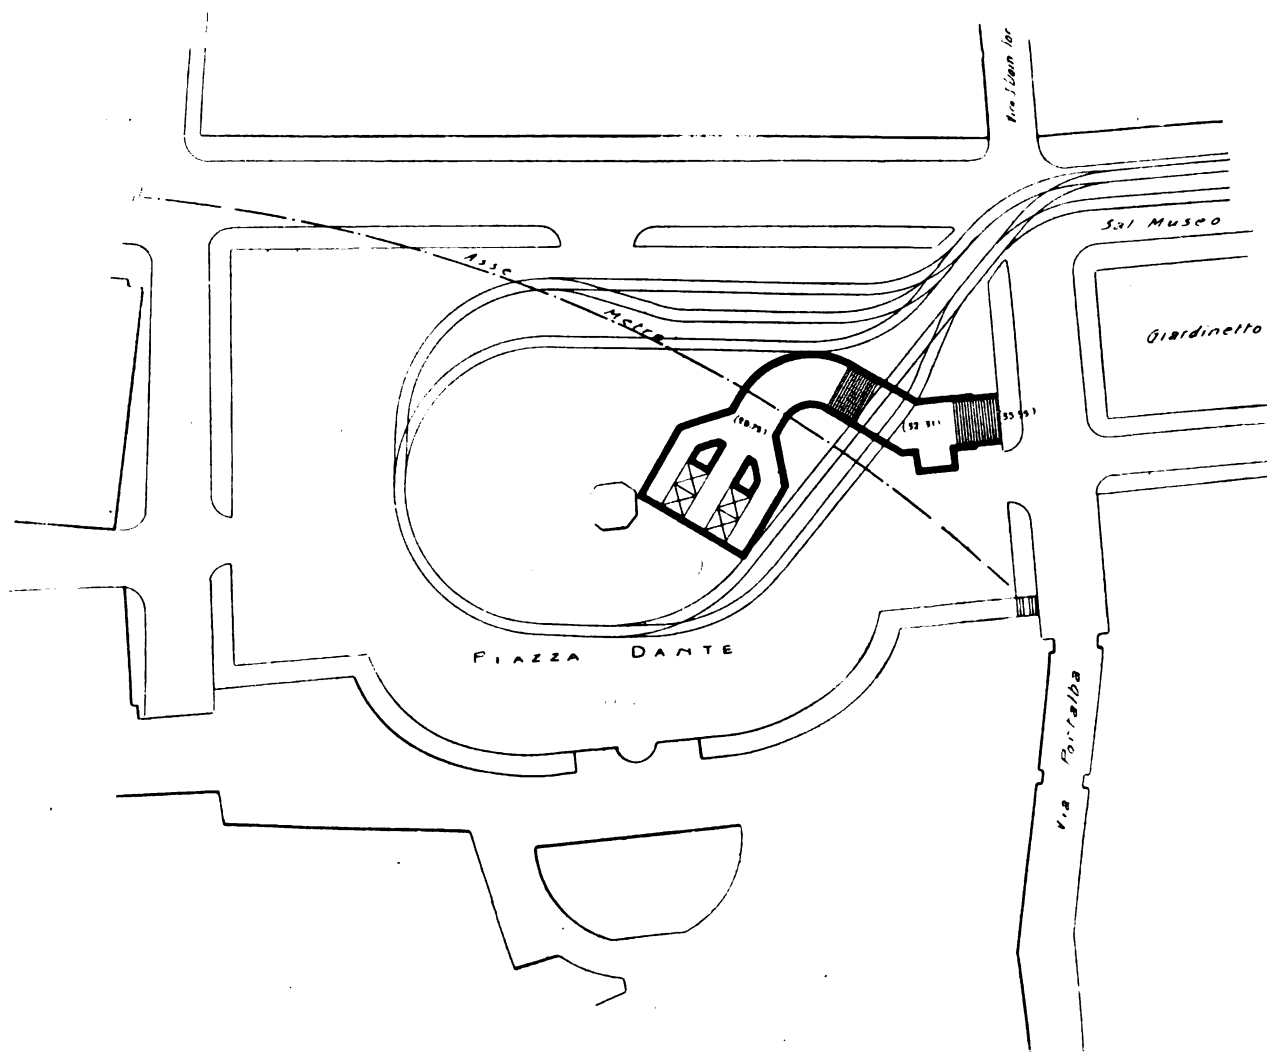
Stazione di Piazza Dante. - Pianta della stazione al disotto del piano stradale.
